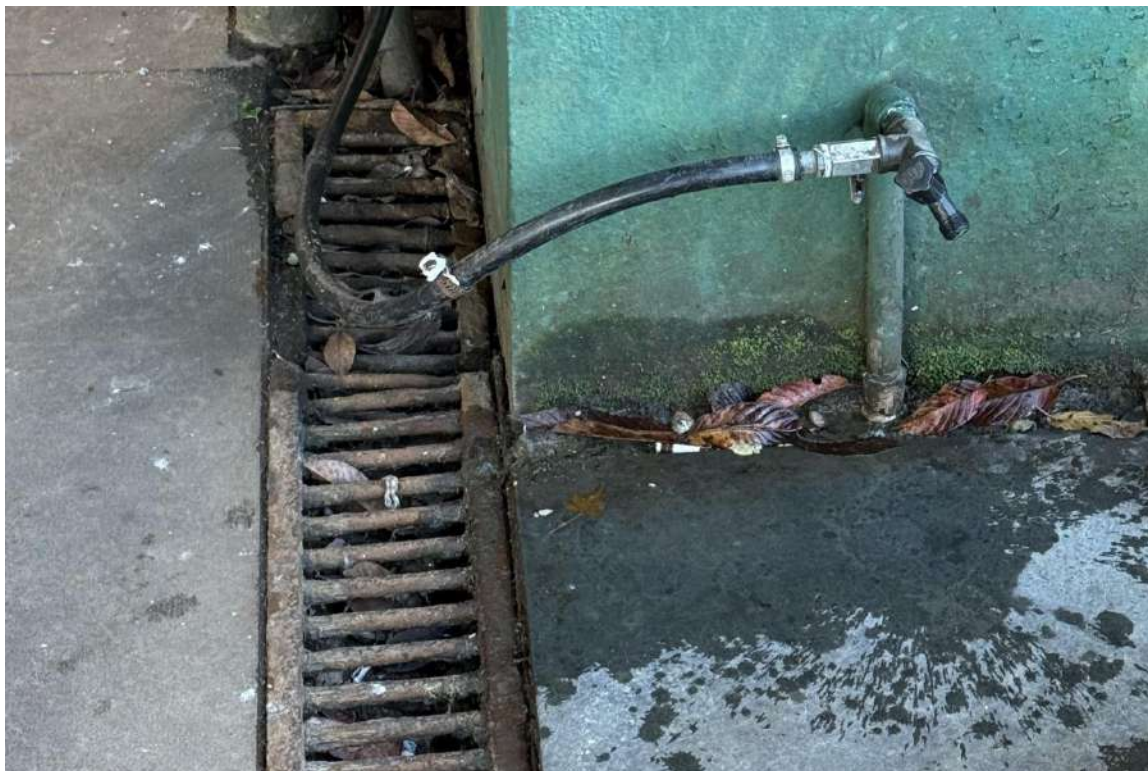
Detalhe de ponto de captação, oxidação e elemento improvisado
